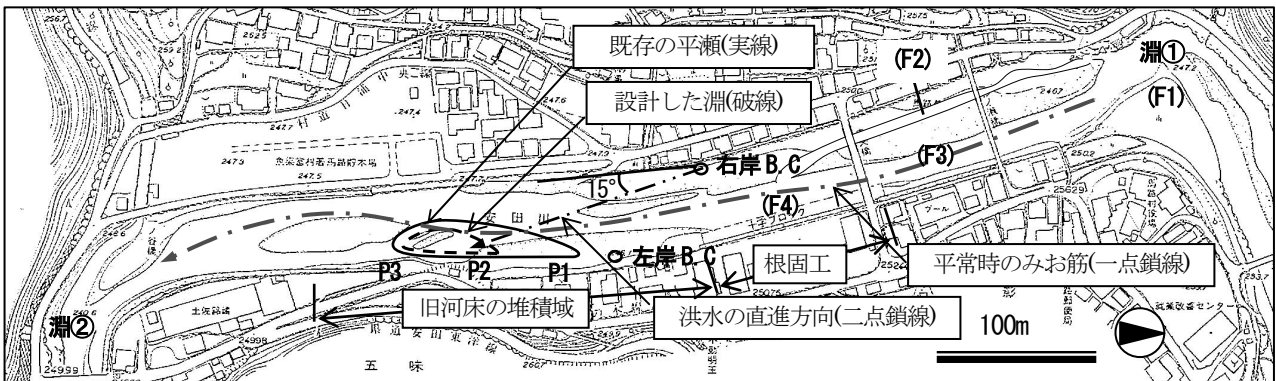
対象区間平面図(F1~F4 は魚類の調査地点を示す)
